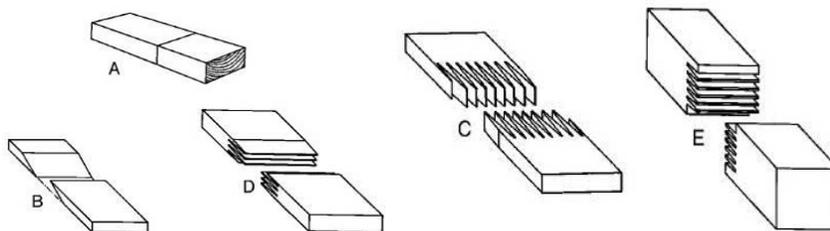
Uniones encoladas: A, unión de punta; B, unión de corte simple; C, unión vertical estructural *fingerjoint*; D, unión horizontal estructural *fingerjoint*; E, unión no estructural *fingerjoint*.
